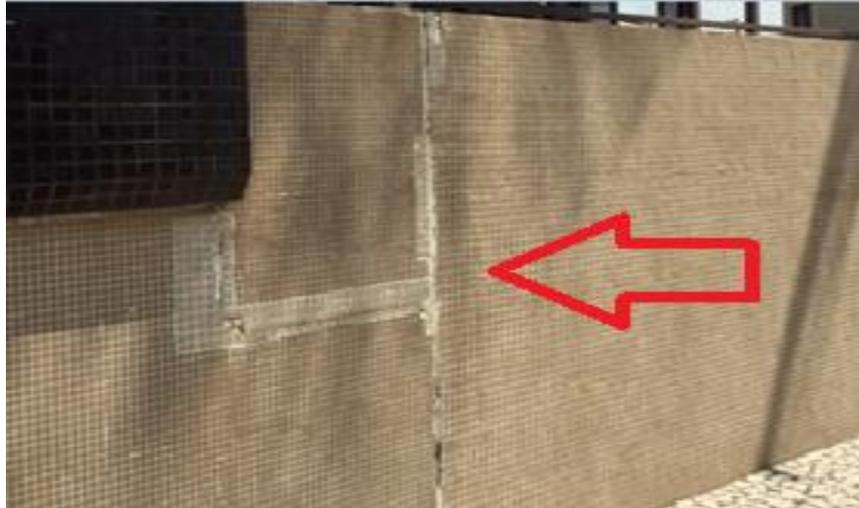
Fissura na fachada do Condomínio D.
